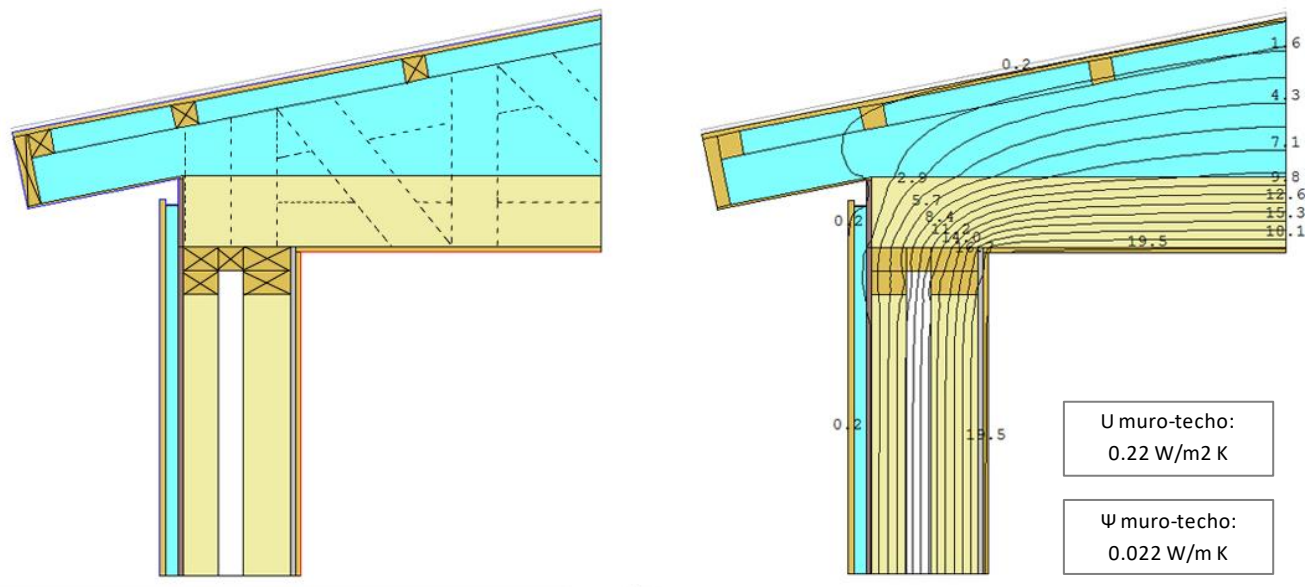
Detalle y diagrama de isotermas unión muro-techo, en vista de corte utilizando doble tabiquería.
